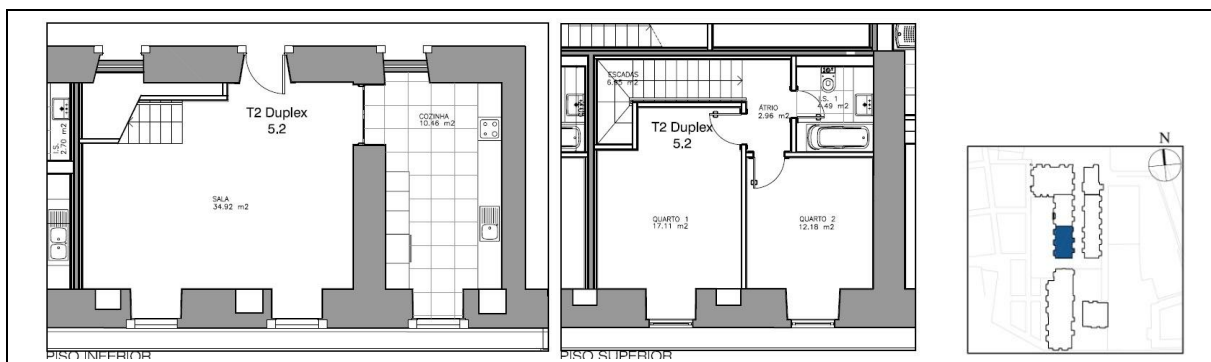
Planta e localização das habitações T2 Duplex [98]
